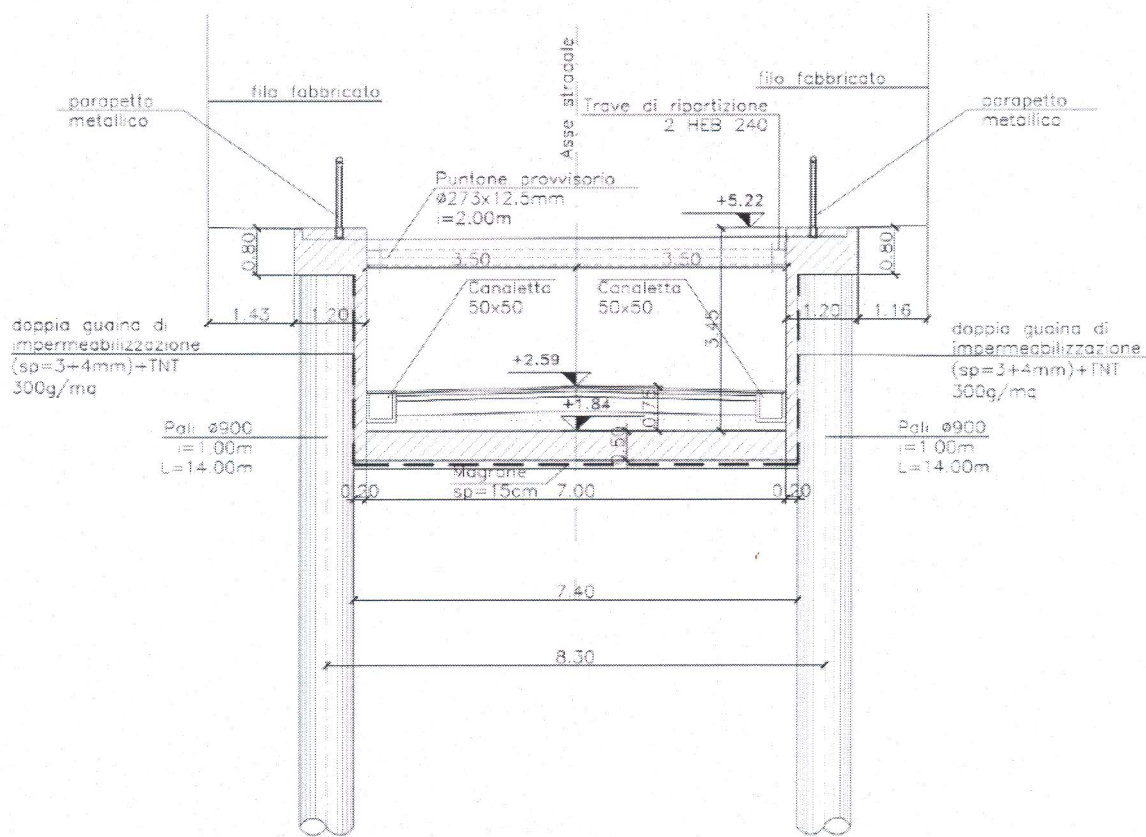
Sezione trasversale tra pk 0+108.25 e 0+113.25
